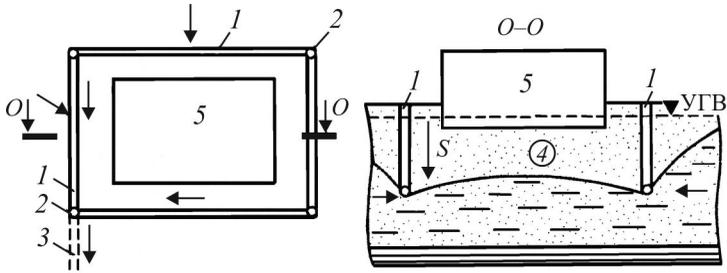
Кольцевой дренаж вокруг здания, сооружения (план и разрез участка): 1 – дрены; 2 – смотровые колодцы (дренажные колодцы); 3 – сбросная часть дренажа; 4 – пониженный уровень грунтовых вод; 5 – здание; S – величина понижения статического уровня грунтовых вод
